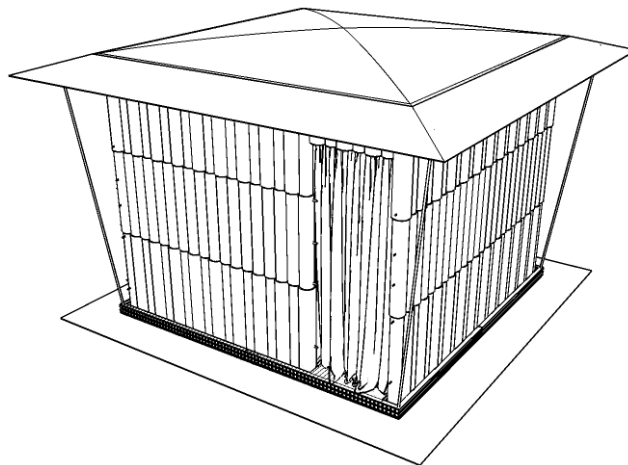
Abrigo finalizado después de la colocación de las telas para cerramiento de puertas. Fuente: Desarrollado por el autor
